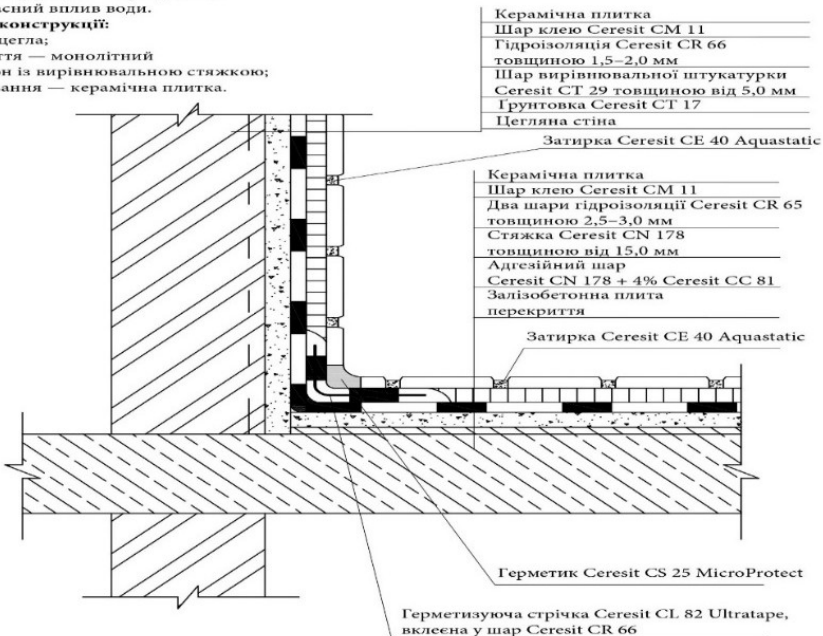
Конструкція системи гідроізоляції побутових душових, ванних кімнат, санвузлів, пральних приміщень, кухонь (матеріал перегородок – цегла, підлога – монолітна залізобетонна плита).
